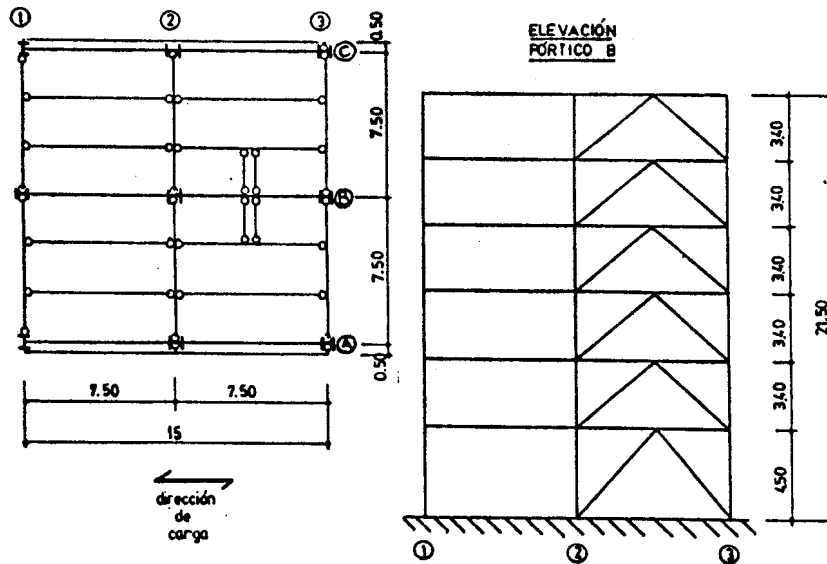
EDIFICIO DE ACERO- ESTRUCTURA DE ENSAYO
